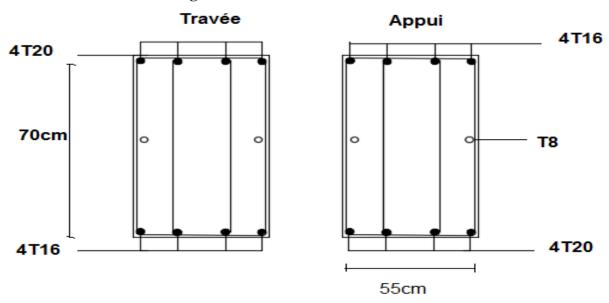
Schéma de ferraillage des nervures (sens porteur)
